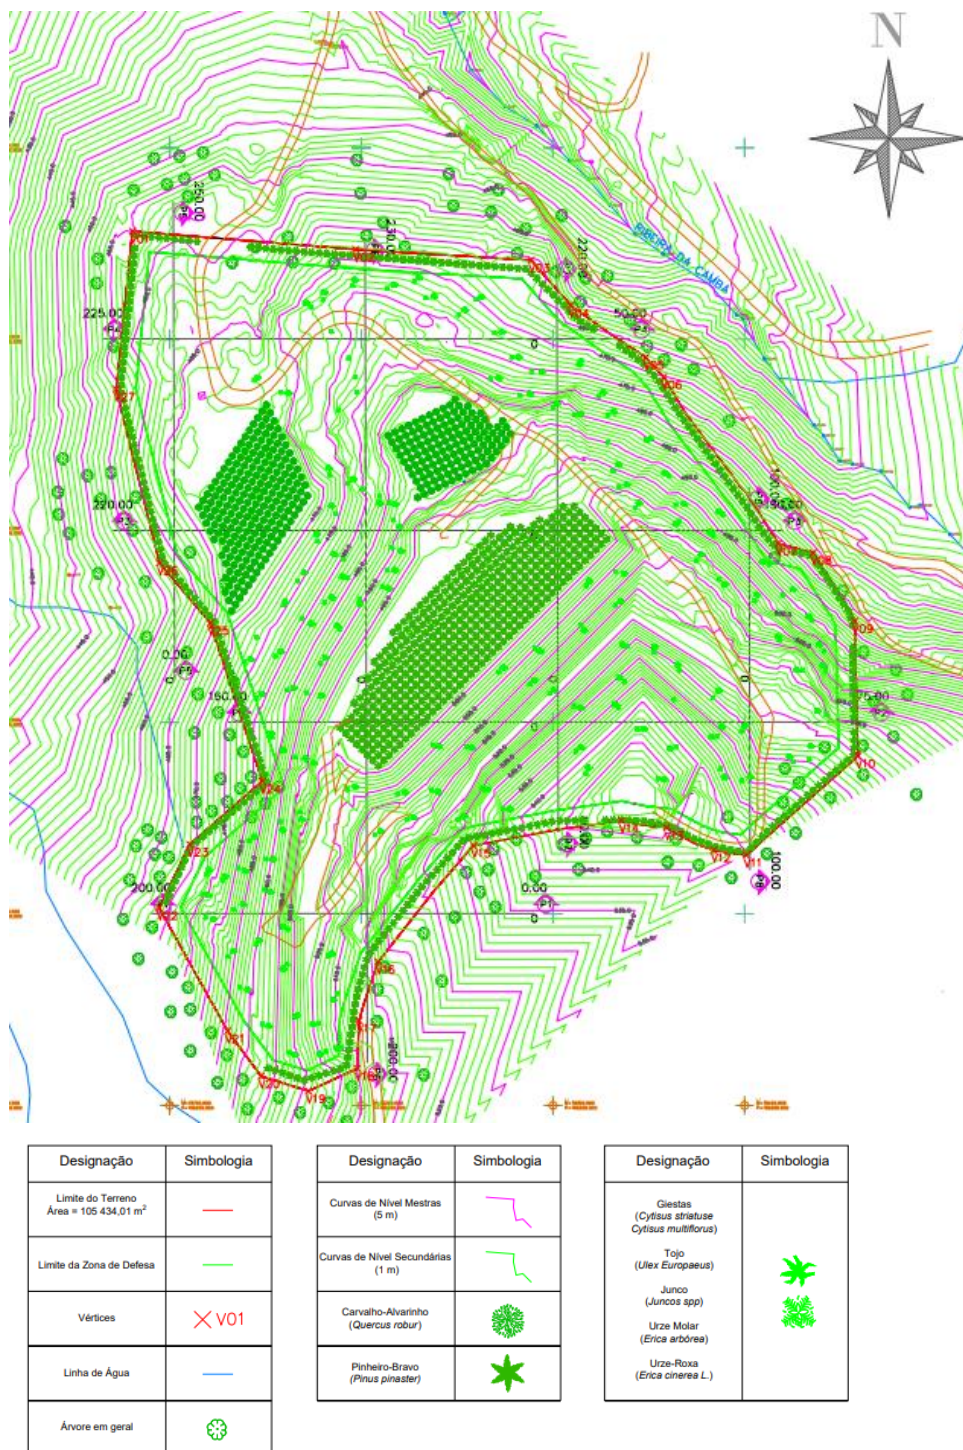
Planta de recuperação paisagística. Fonte: PARP
